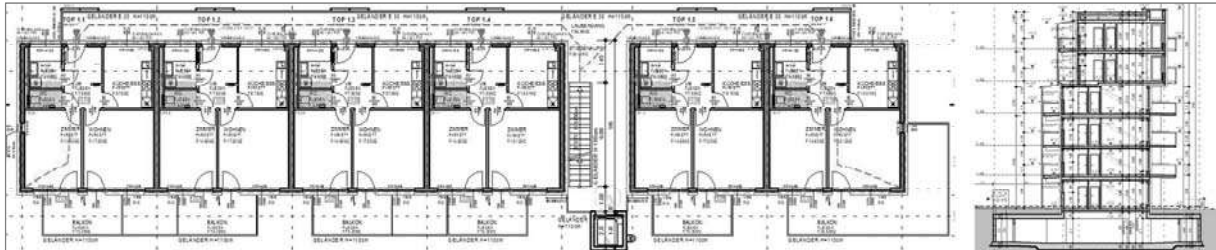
Grundriss (Regelgeschoß) und Querschnitt des Beispielwohnbaus (maßstabslose Darstellung)
